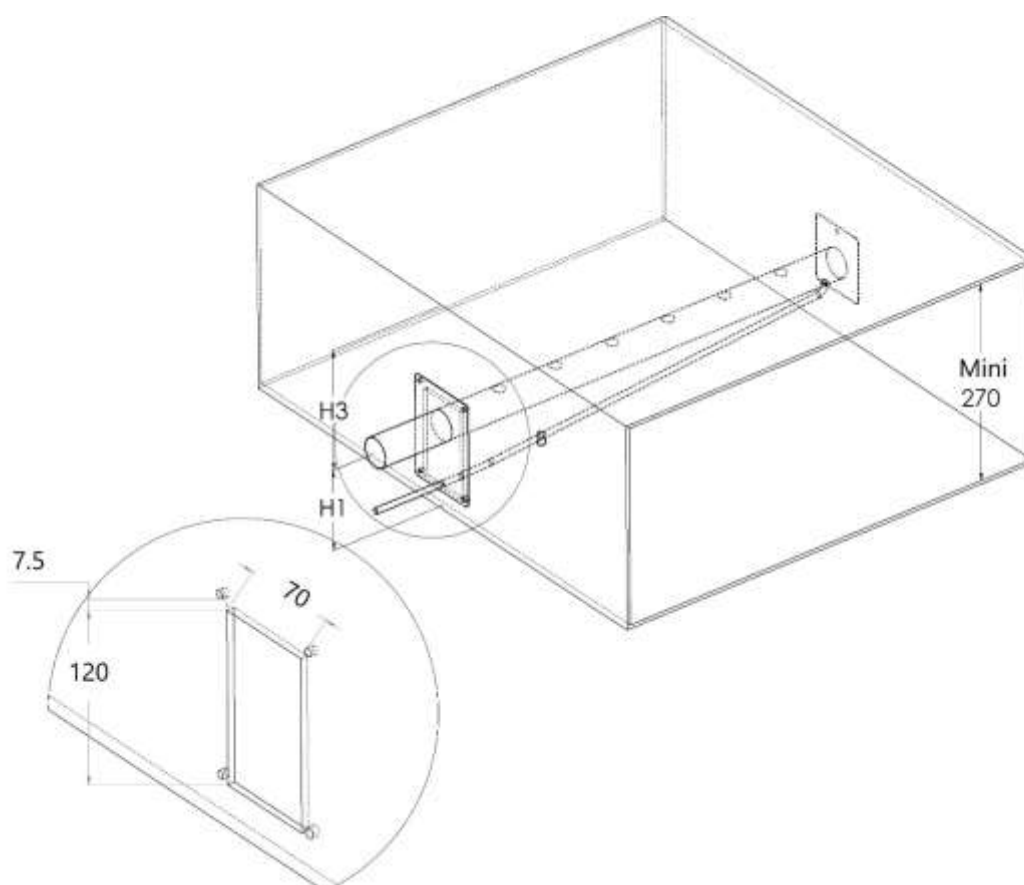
Dimensión del agujero a cortar en el conducto
